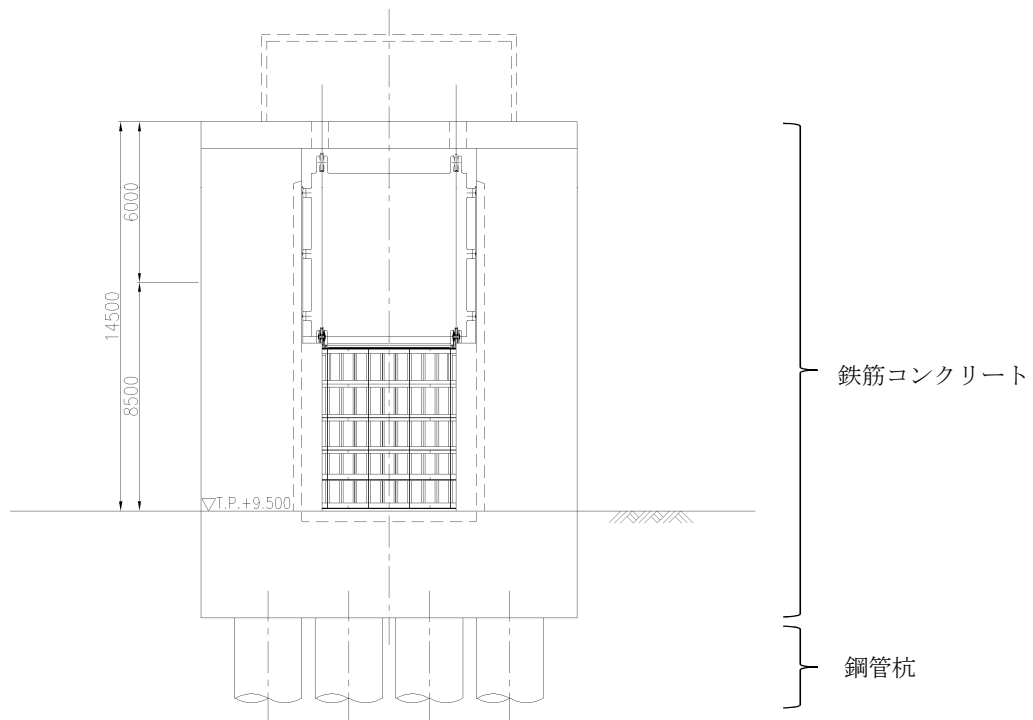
鉄筋コンクリート防潮壁正面図（防潮扉 2）
